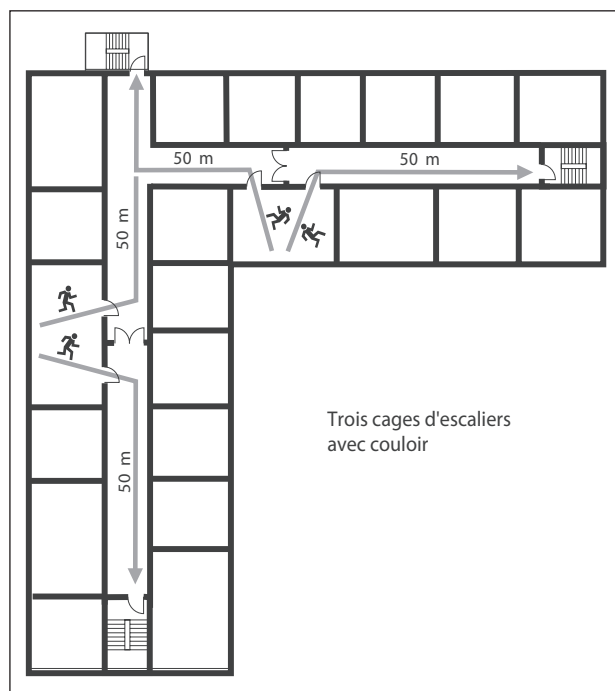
Exemple pour l'emplacement des cages d'escaliers dans le cas d'une construction en L
